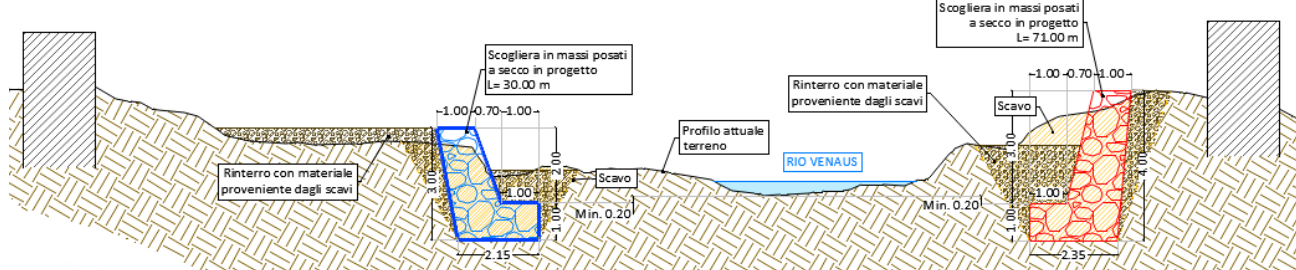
Estratto della Tav.07 Sezioni di progetto.
